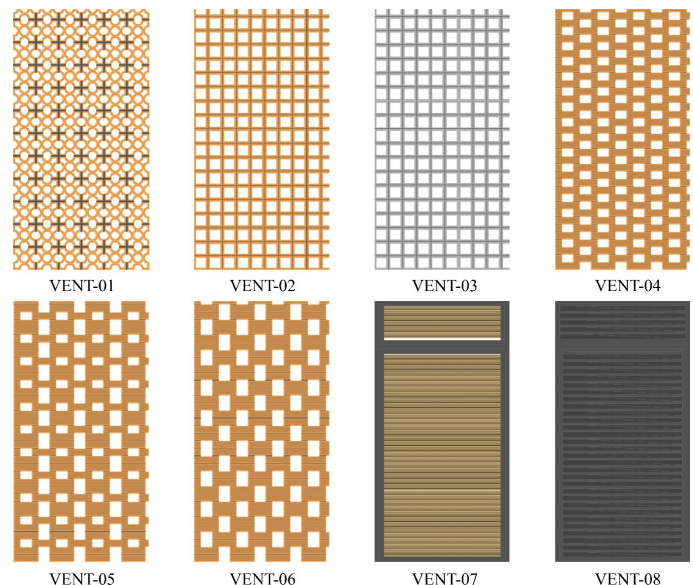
Tipologías de muros ventilados. Fuente: Elaboración de la Autora
